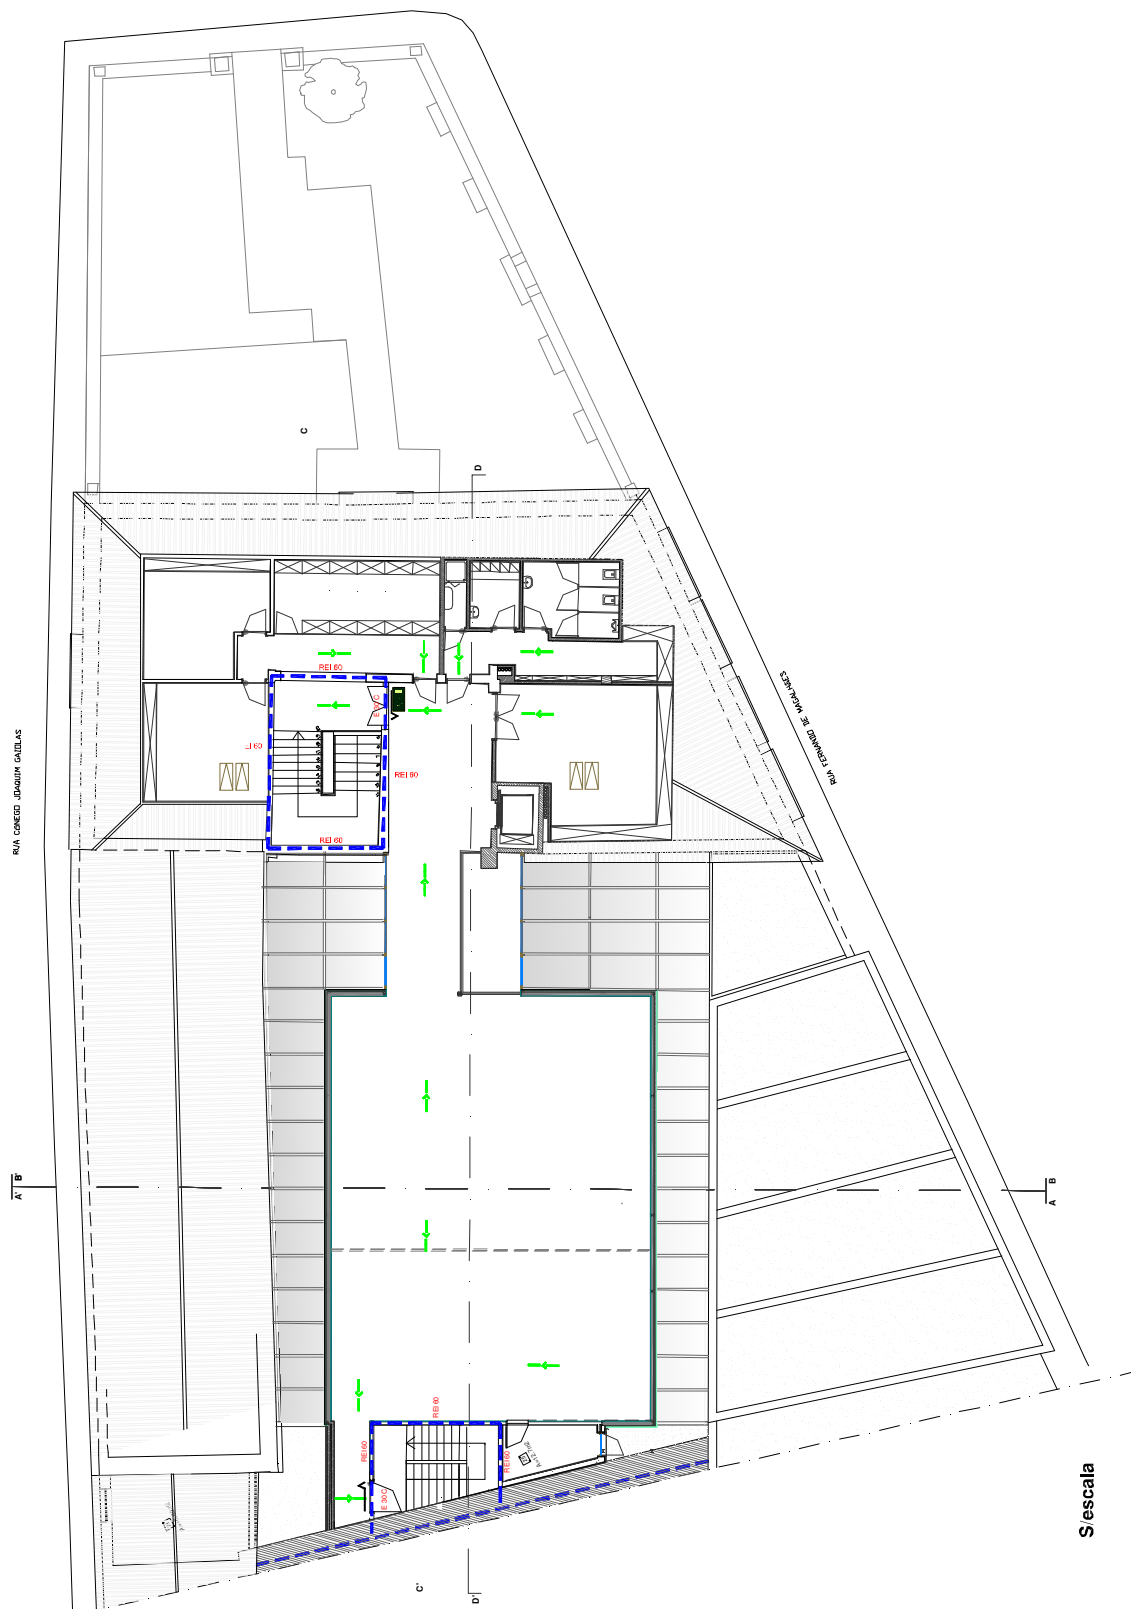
Planta do 3º Piso - Proposta de inclusão de via vertical de evacuação.
